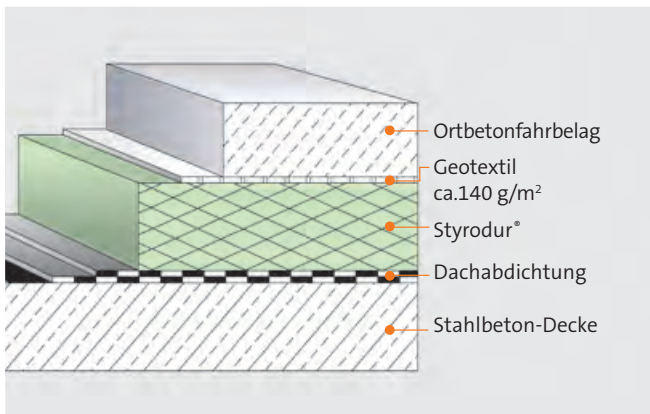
Prinzipskizze eines Parkdaches mit Ortbetonfahrbelag auf einer Umkehrdachkonstruktion mit Styrodur®.
